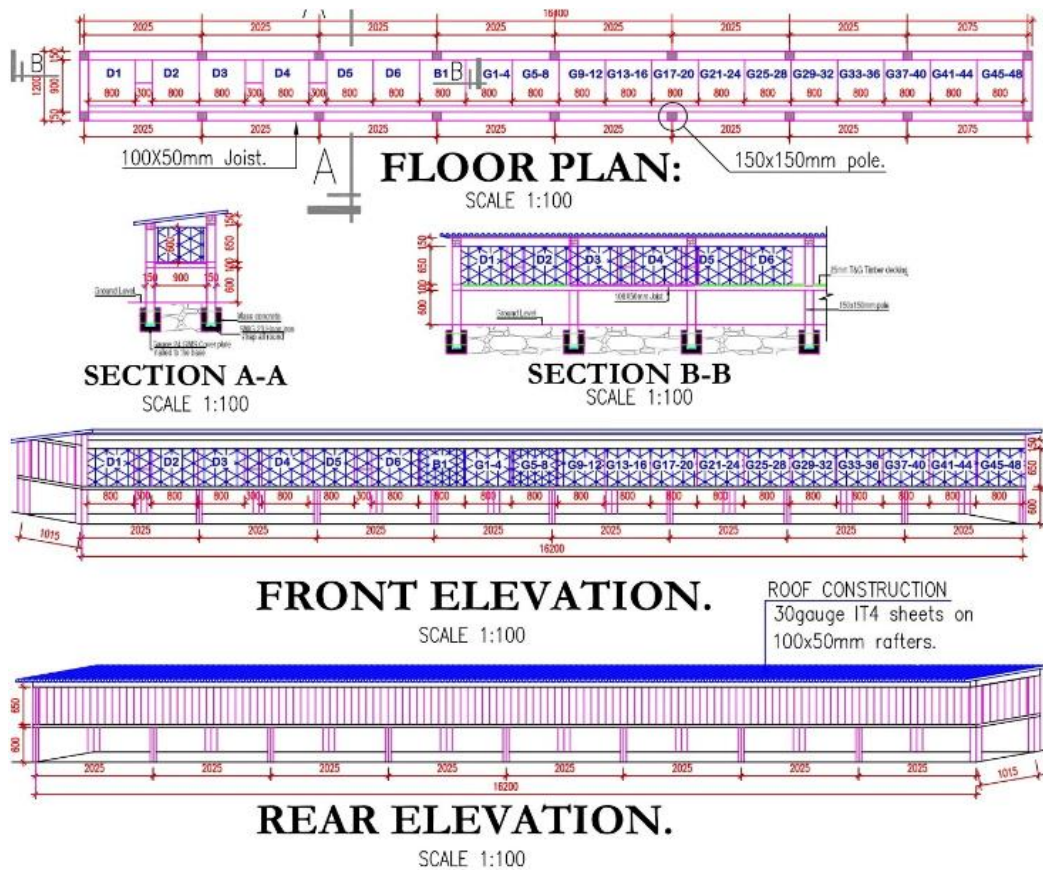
План будиночка на відкритому повітрі для 6 кролів-самок та 1 кроля (господарська одиниця для розведення)
